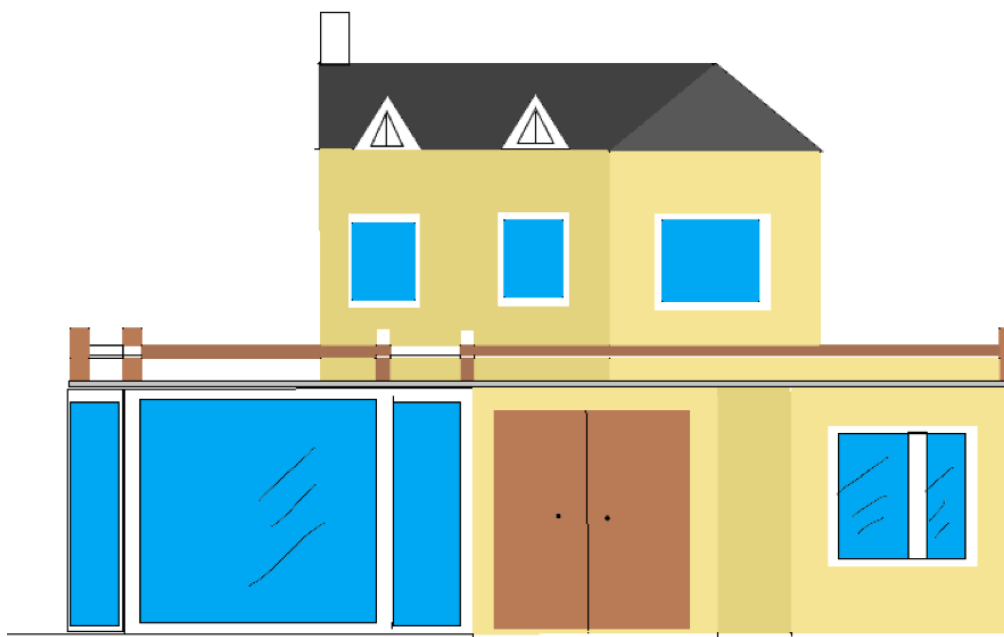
Решение фасадов жилого дома (восточный фасад)
